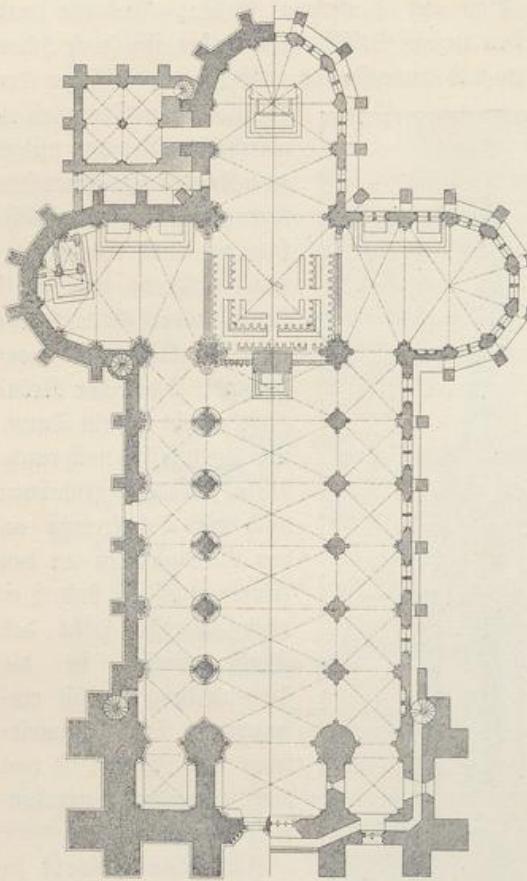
St. Elisabeth. Marburg. Grundriss.
